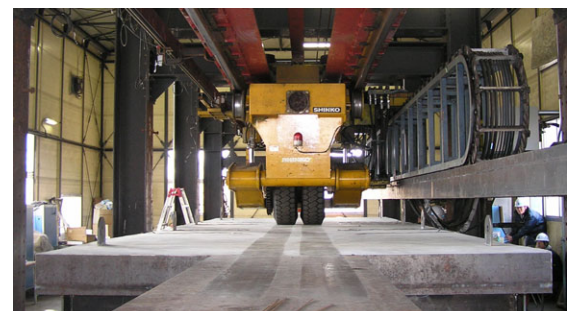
輪荷重走行試験状況(ダブルタイヤ)
